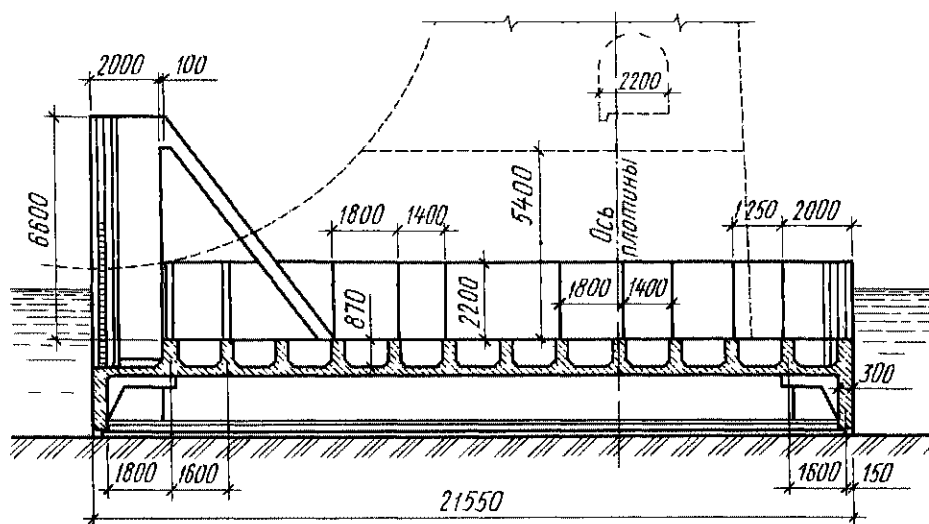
Разрез железобетонного кессона под бетонную плотину Волховской ГЭС
